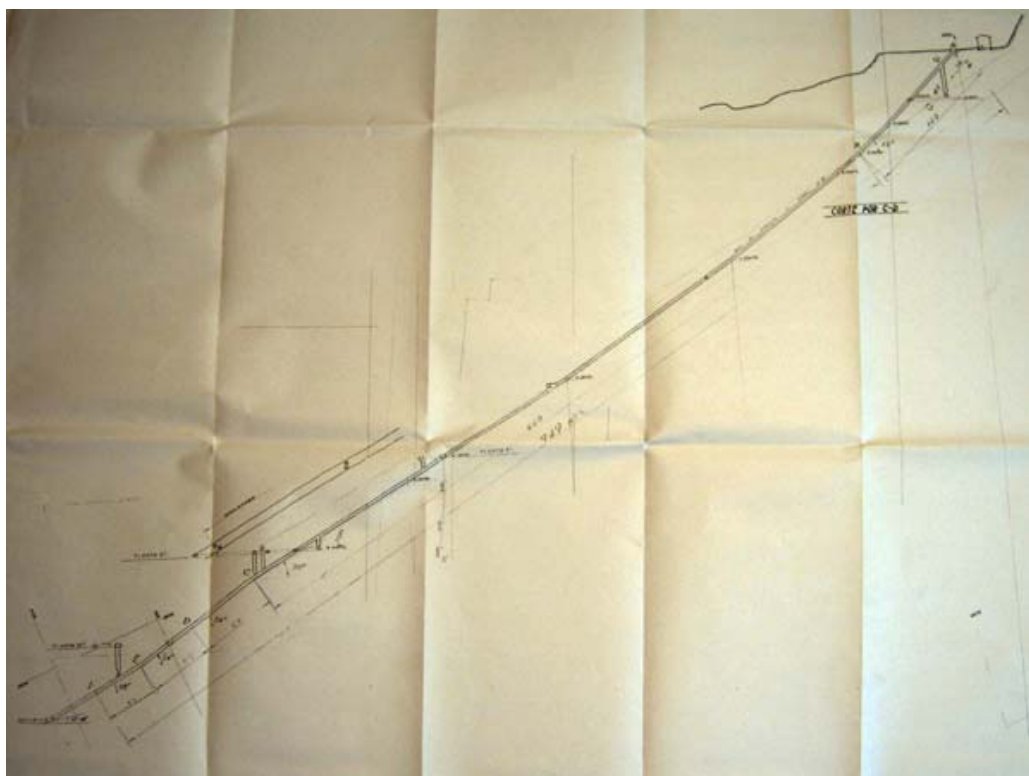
Vista de un corte del plano inclinado Nº 2, de mina La Oportuna, se observa las pendientes, longitud y accesos a plantas.
